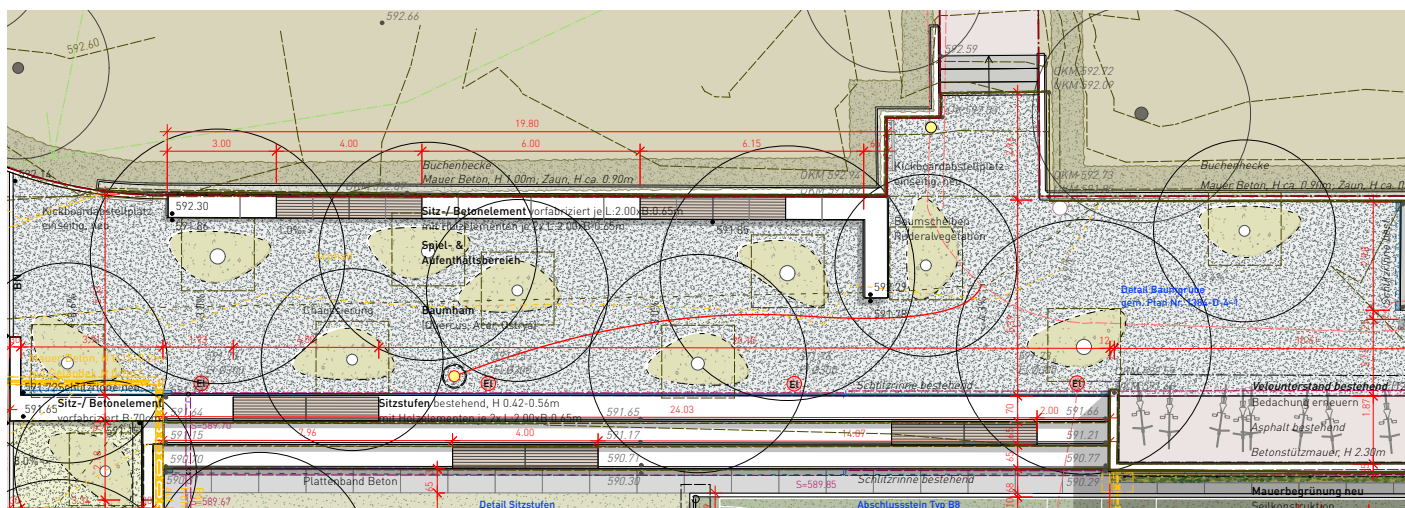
Planausschnitt Umgebungsanpassung Teilprojekt 2
